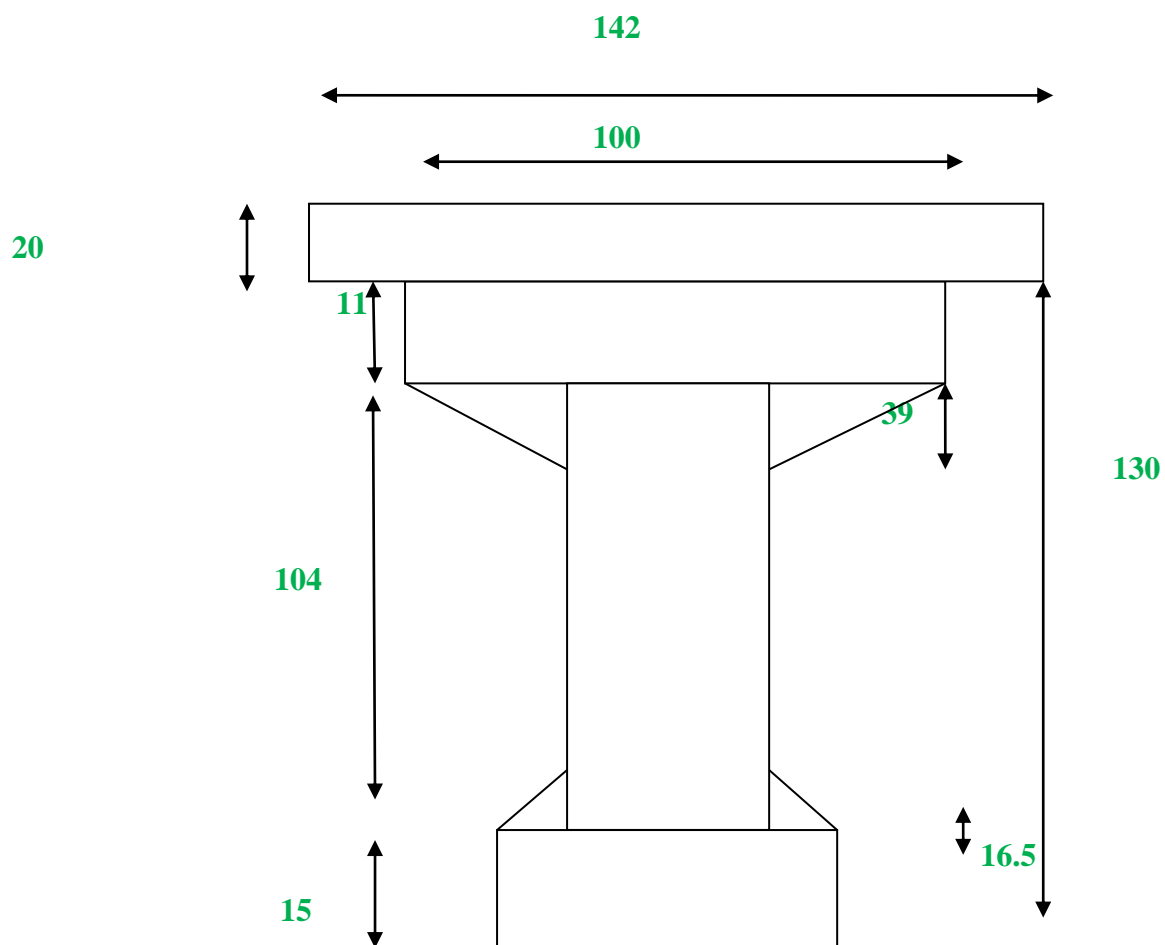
Dimensions de la poutre de rivee A mi travé avec hourdis .
